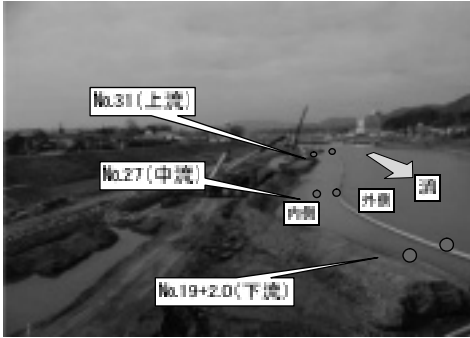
水質測定位置と汚濁防止フェンスの設置状況
